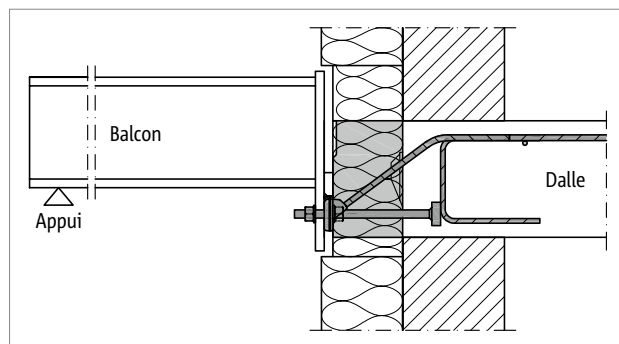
Schöck Isokorb® XT type SQ : passage sans obstacle grâce au décalage en hauteur
